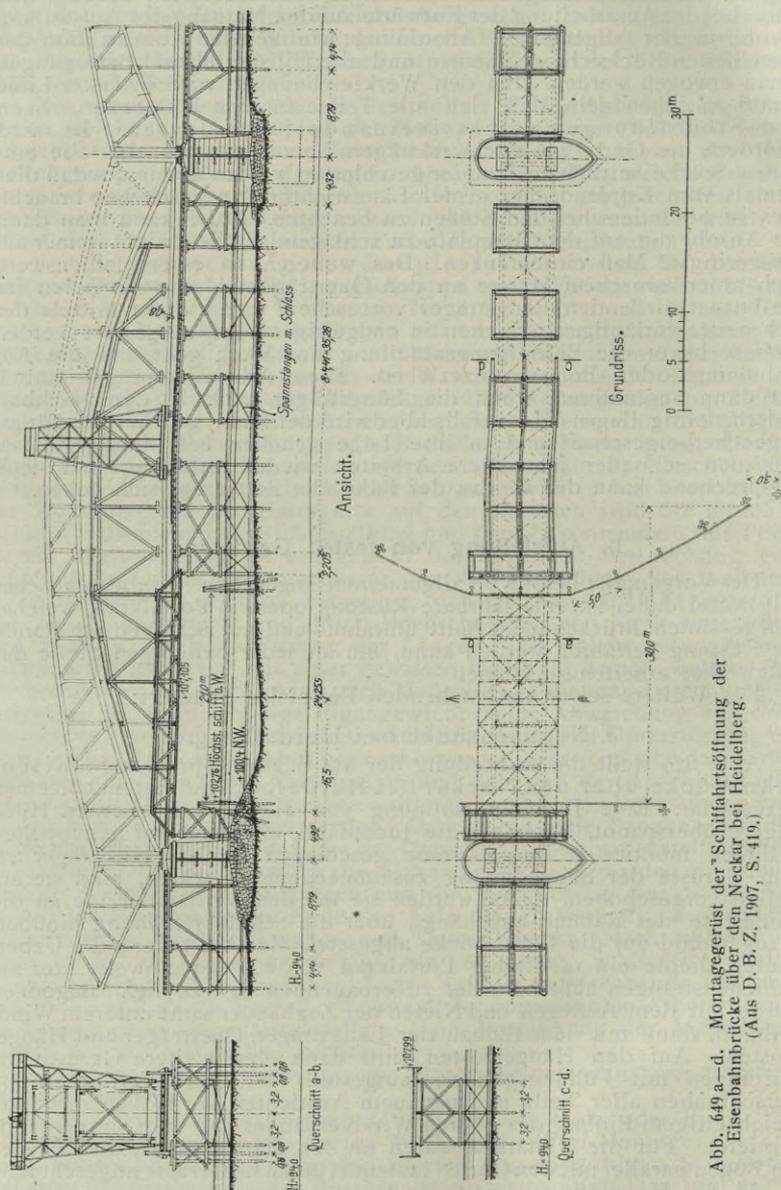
a-d. Montagegerüst der Schiffahrtsöffnung der Eisenbahnbrücke über den Neckar bei Heidelberg. (Aus D. B. Z. 1907, S. 419.)
